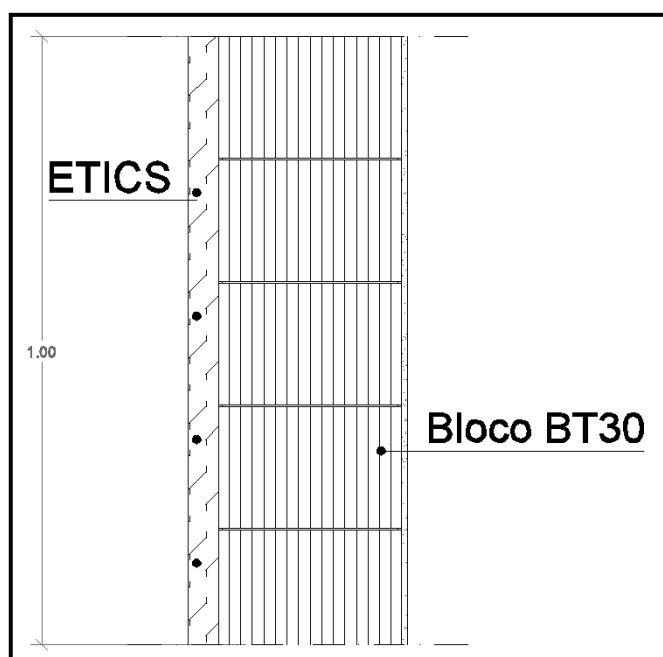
Pormenor em planta, da solução preconizada de parede de pano simples
